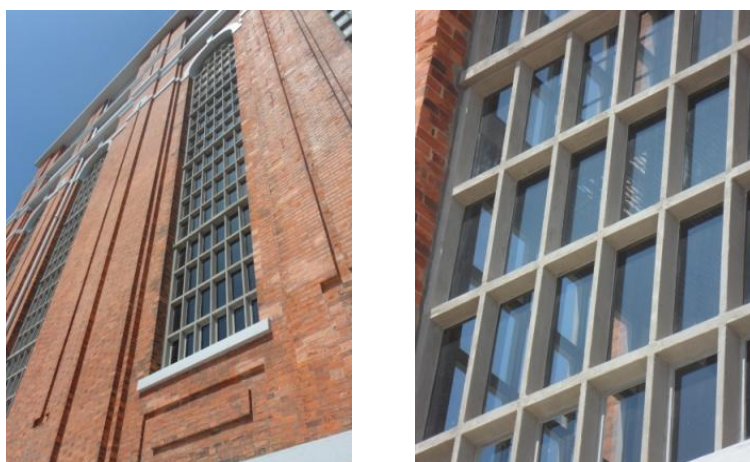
Janelões em betão armado. Fachada Sul da AP.
